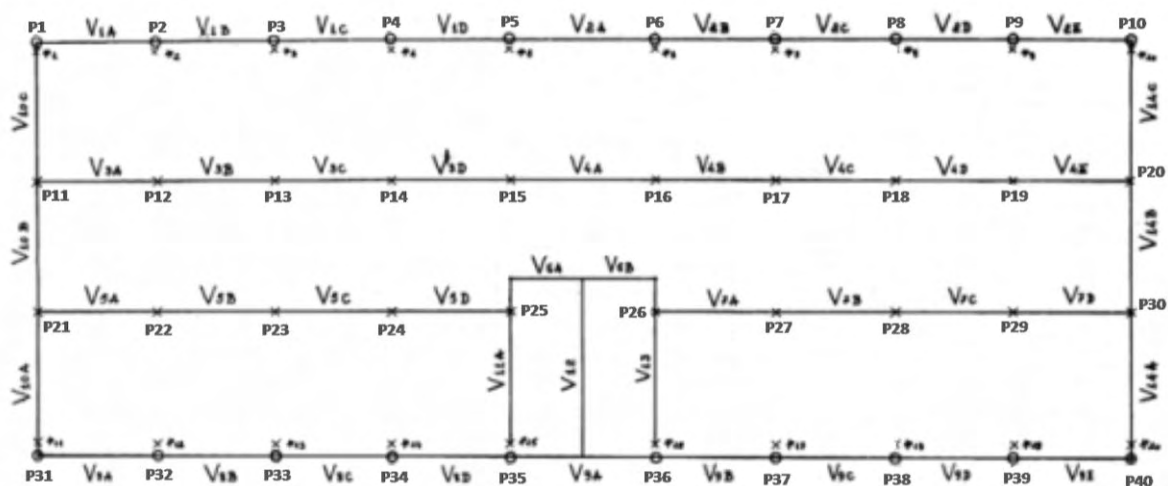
Planta estrutural do sub-tecto do R/C.
